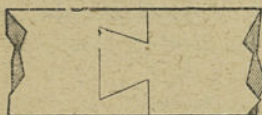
Enture à « queue d'hironde » pour assemblage de pièces en prolongement l'une de l'autre.
